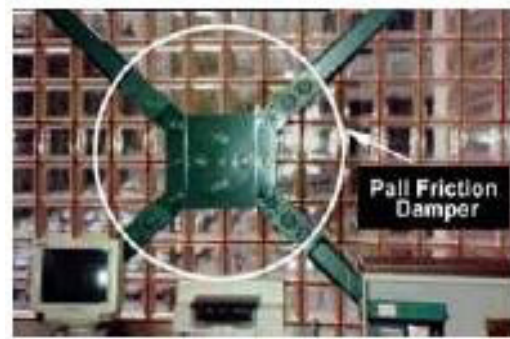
Friction Damper* utilizado nas estruturas da McConnell em Montreal.
